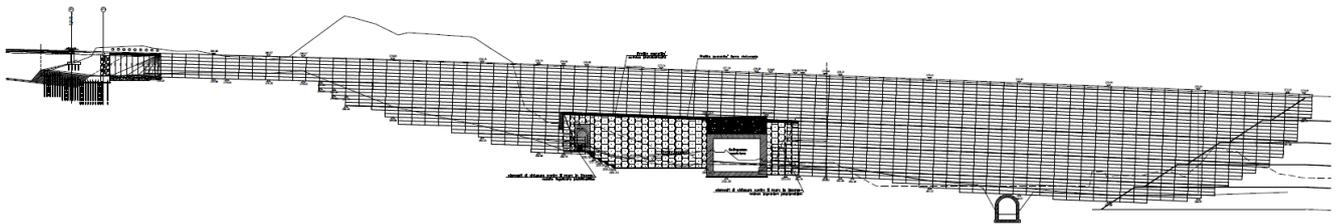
Prospetto geometrico del rilevato in terra rinforzata tra le gallerie "Selva Piana" e "Paniga".
